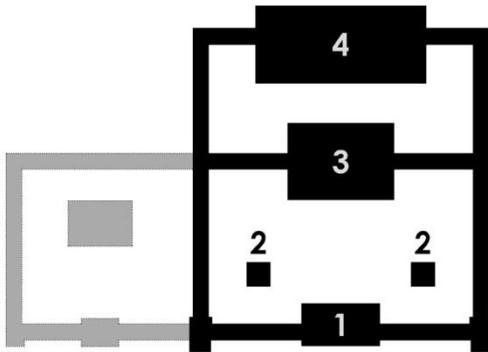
, Grundriss des Bulguksa, Südkorea
